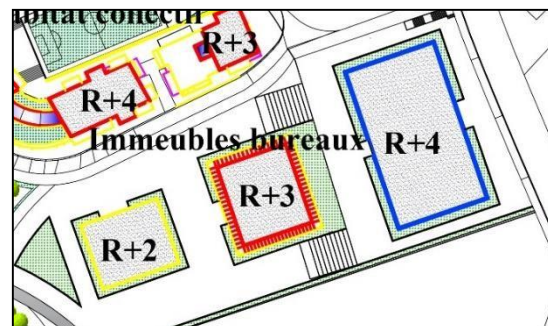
Vue en plan sur les immeubles bureaux projetés
